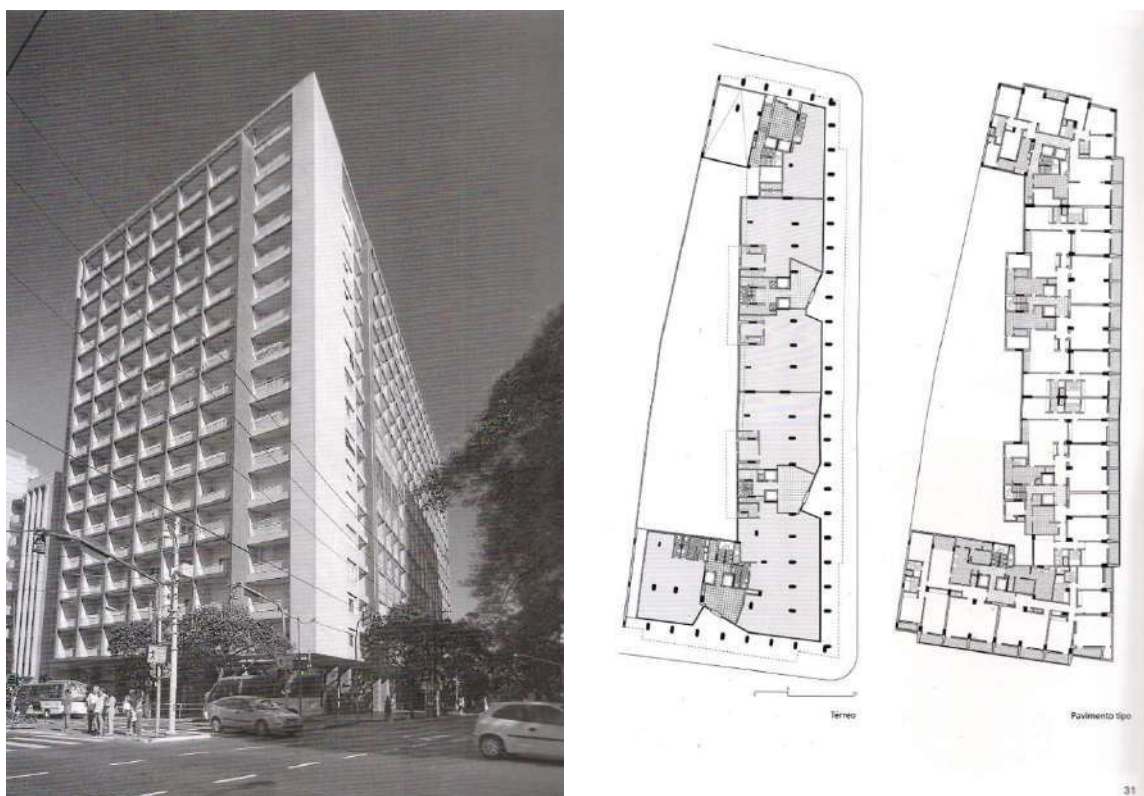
Edifício Esplanada, vista de uma das esquinas (esquerda) e plantas baixas do pavimento térreo (centro) e do pavimento-tipo (direita).
